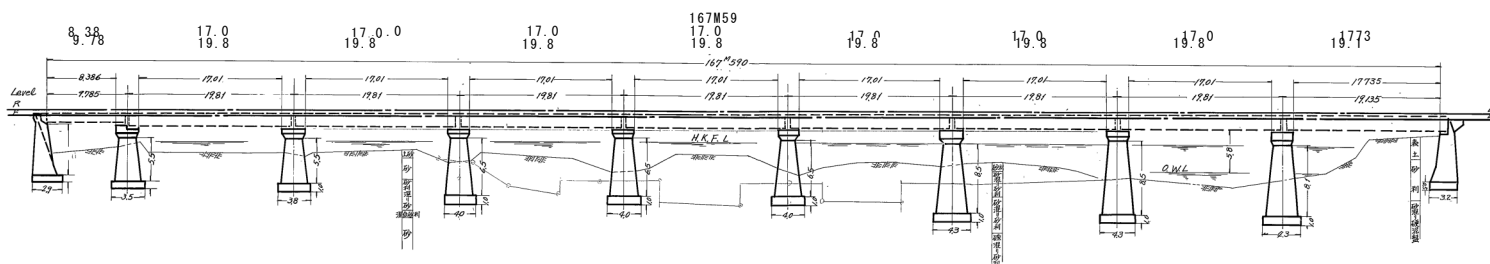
気仙川橋りょう側面図 (単位: mm)
